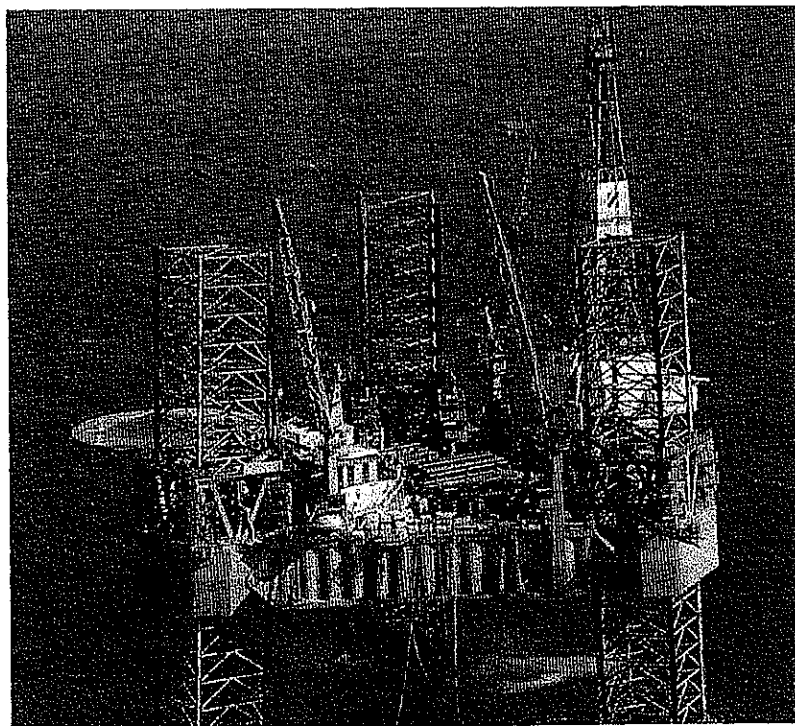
Plate-forme autoélevatrice en forage (Source : Zapata).
